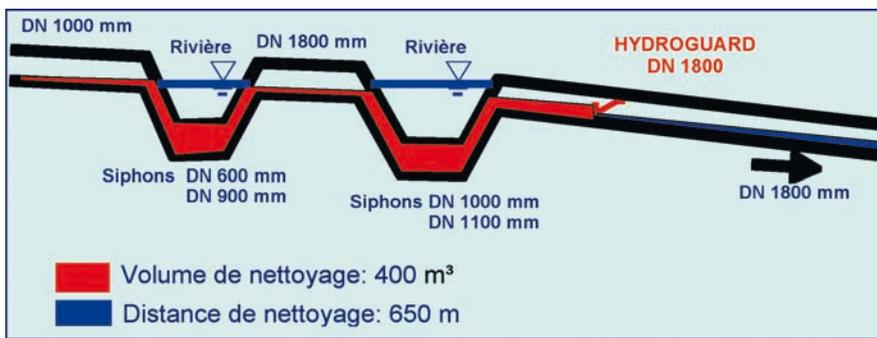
Coupe en long du réseau : collecteur principal n° 2.
